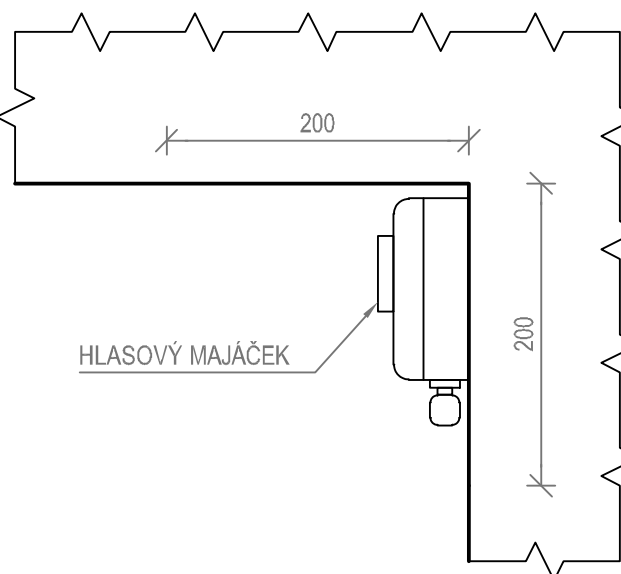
DETAIL UMÍSTĚNÍ SVĚTIDLA (SO 36-11)
